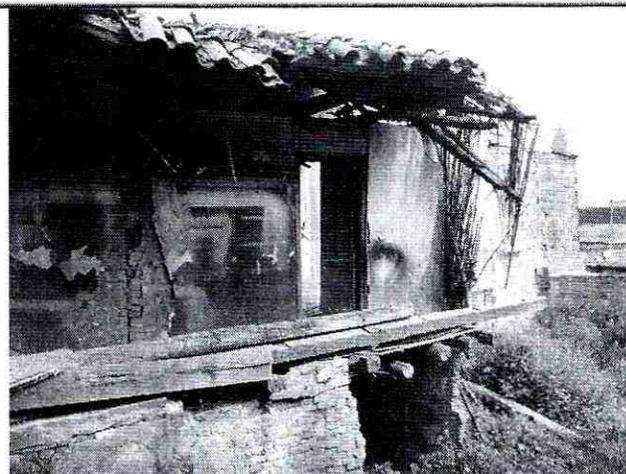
Estructura al interior del predio de la calle 7 # 4-07 Sur.
